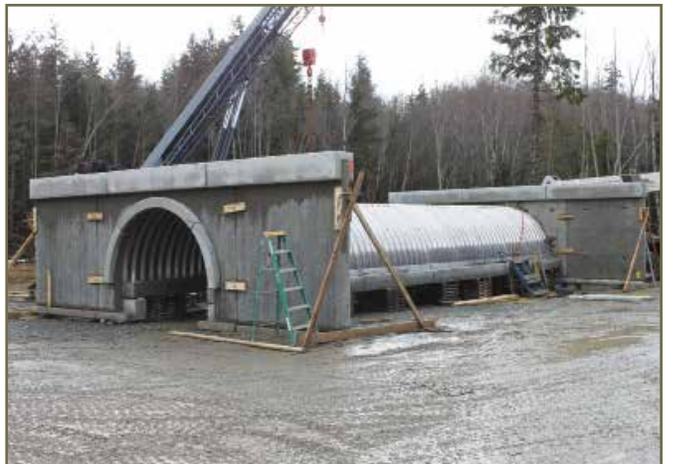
Ponceau arqué préassemblé hors site © K. Williams
